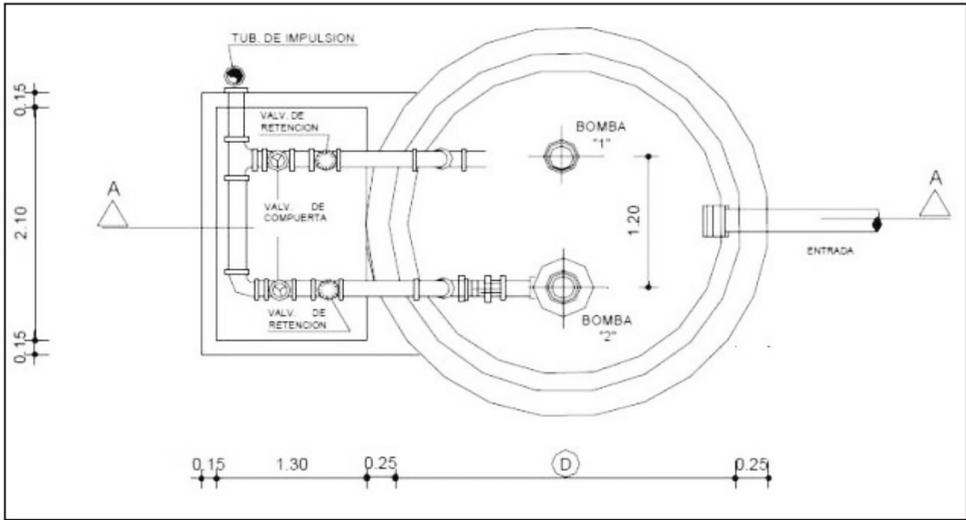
Estación de bombeo tipo. Bomba sumergible. Planta.
